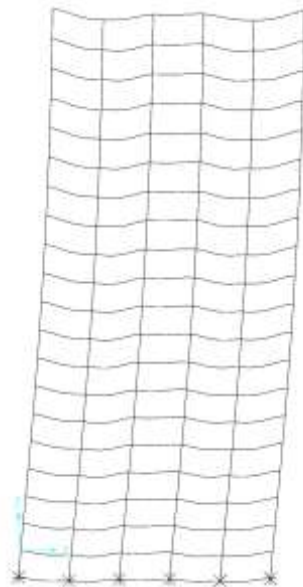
Deformadas – Corte Transversal passando pela Viga V12 – Caso 2 – Com o vento
